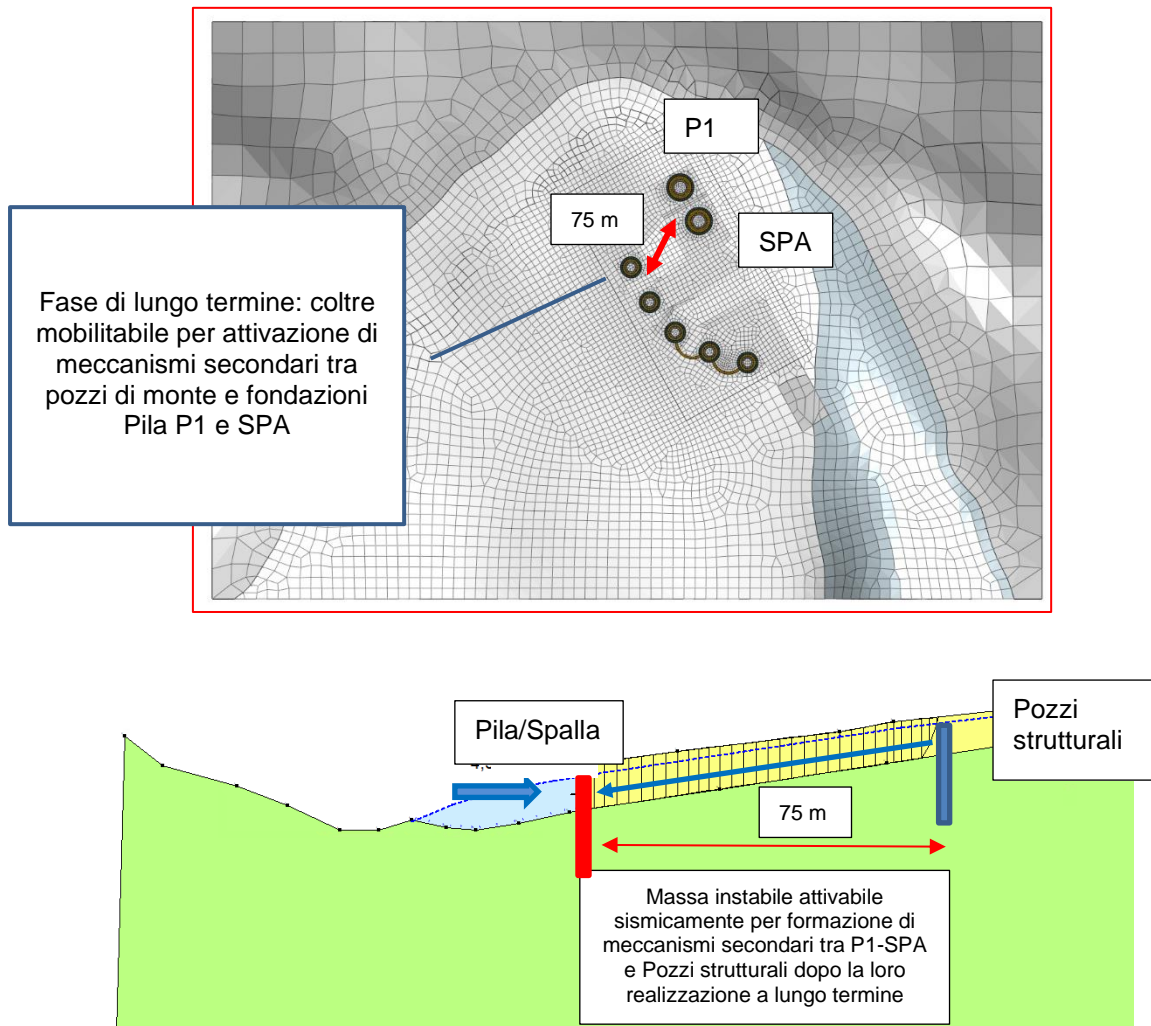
Schema concettuale per la determinazione delle spinte di frana su Pila 1 e spalla A a lungo termine
